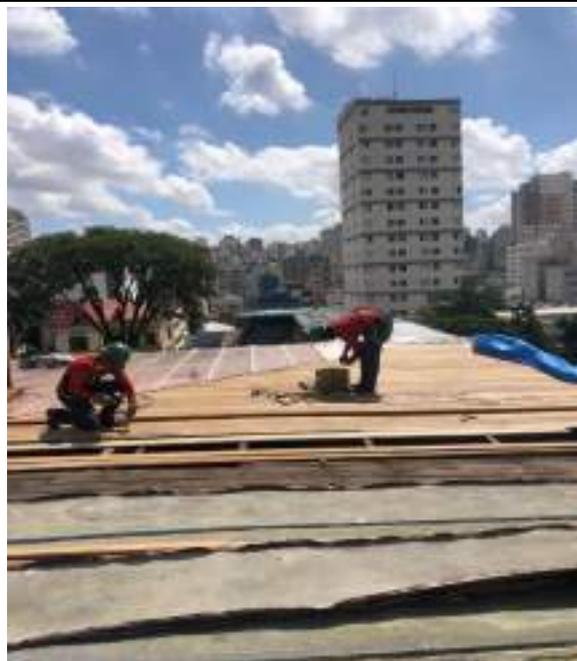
Conservação da cobertura, abertura para instalação de assoalho em madeira.
